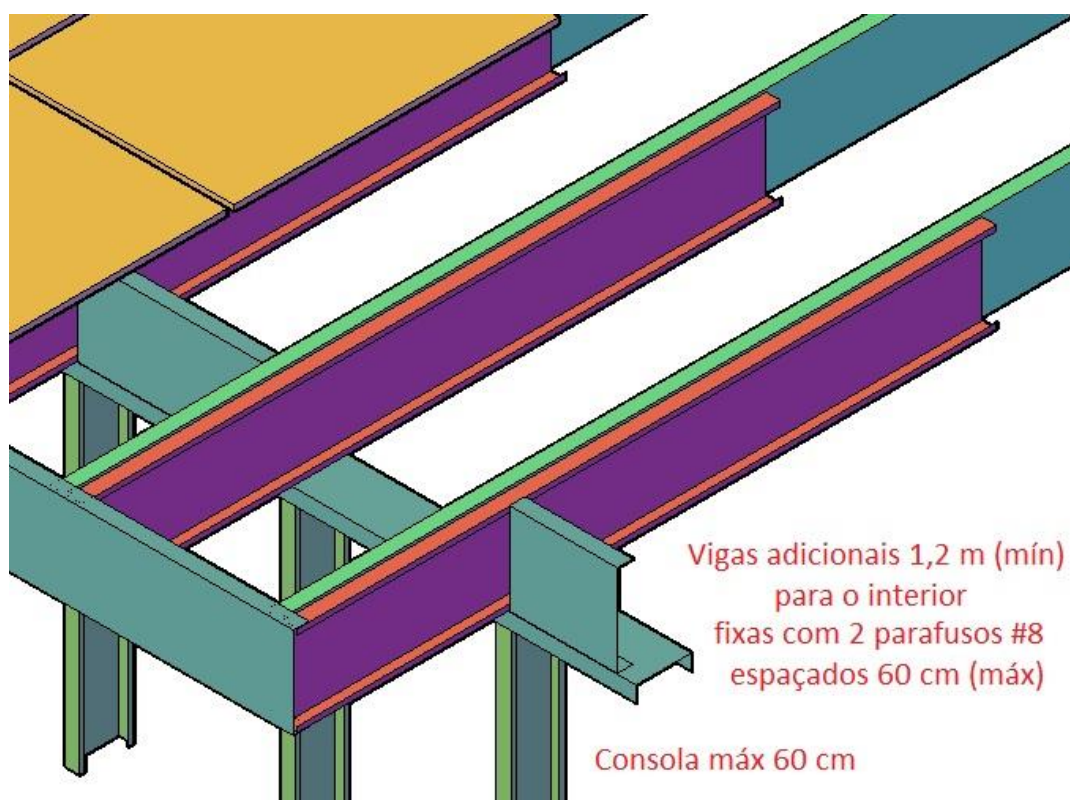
Fixação de pavimento em consola sobre fundação em betão
